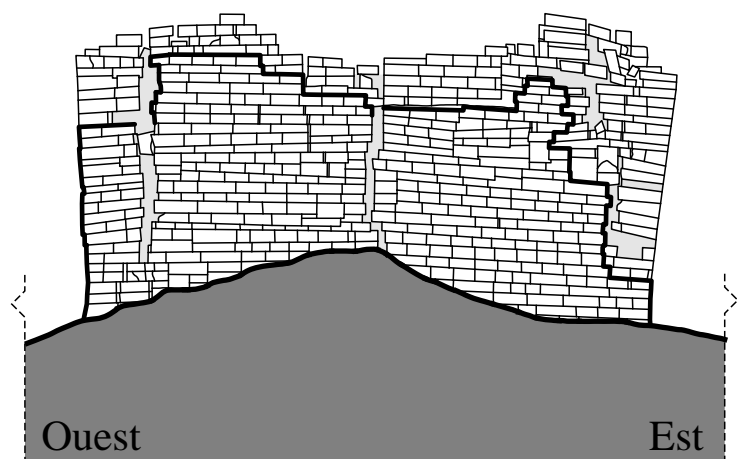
Plan d'un des édifices en briques
